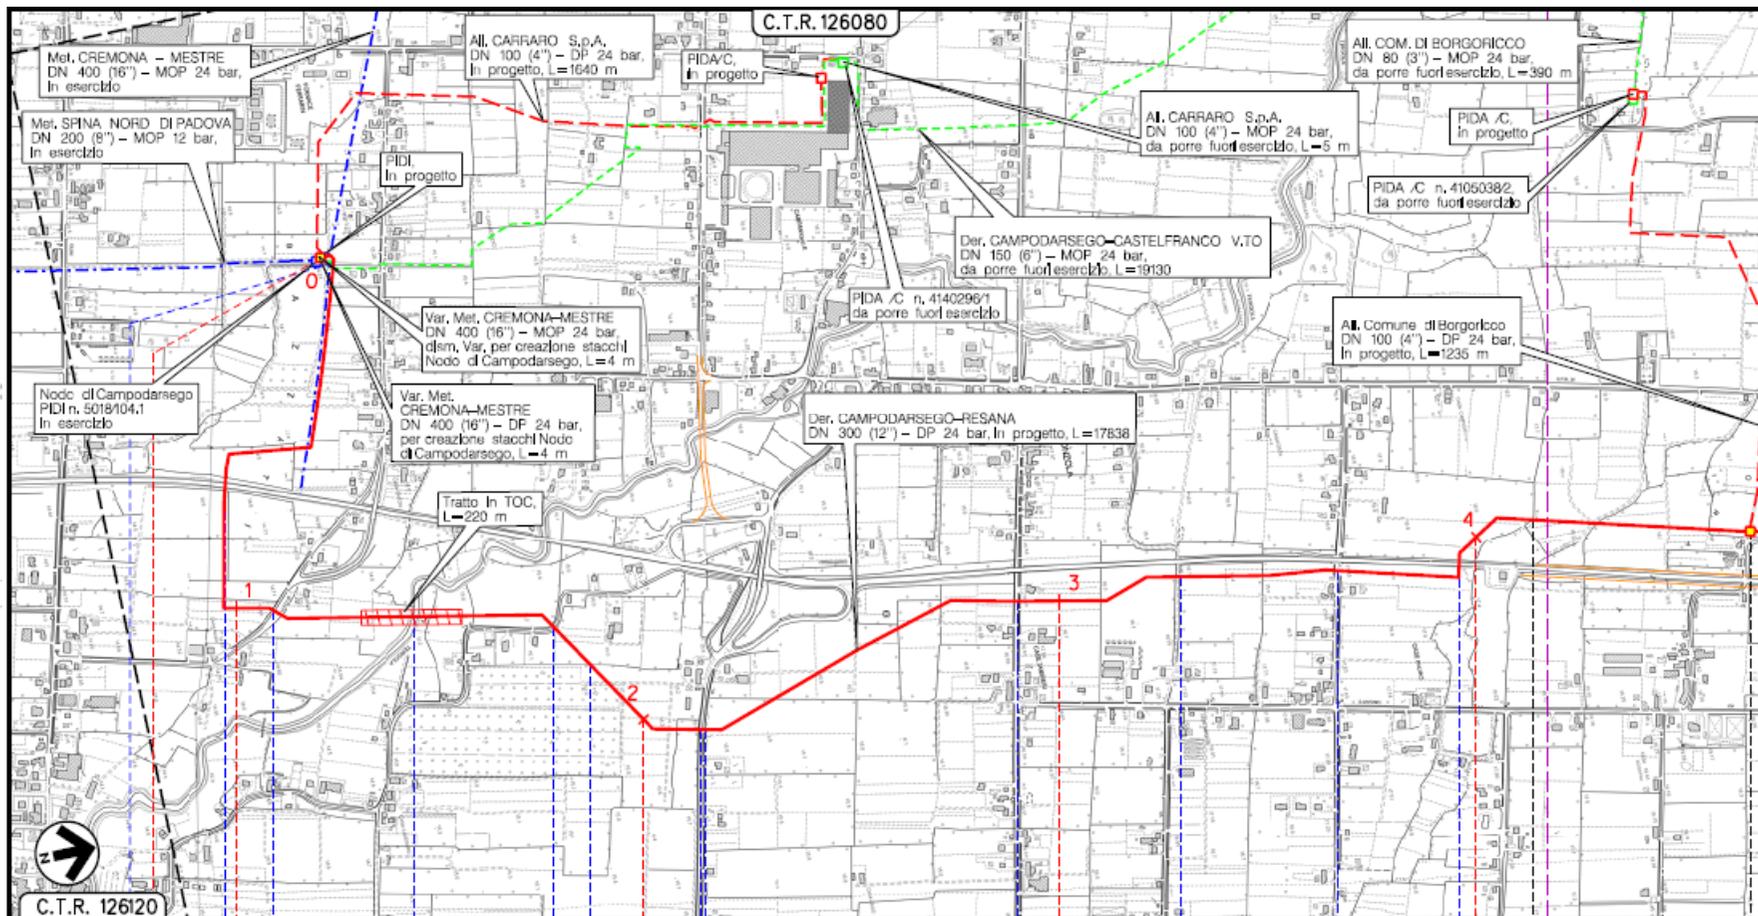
1^ TRATTO - Stralci planimetria CTR con localizzazione dell'area di intervento
